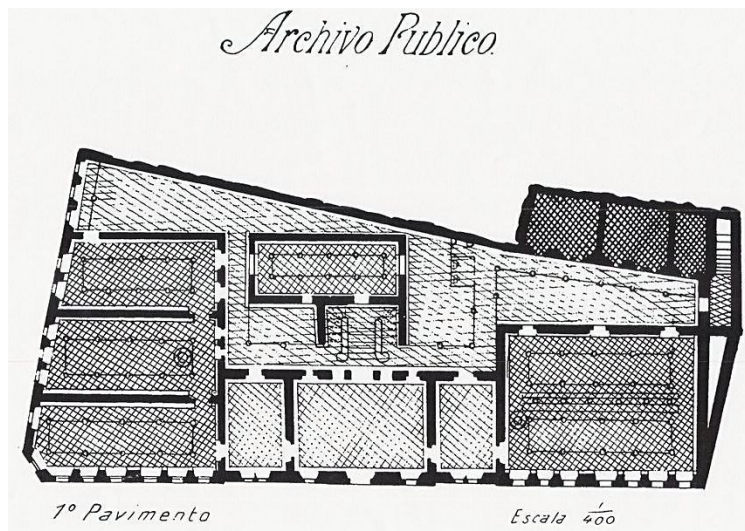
Planta baixa do primeiro pavimento, pertencendo ao Relatório de 1906, indicando a fachada chanfrada na esquina (reprodução fora da escala)
